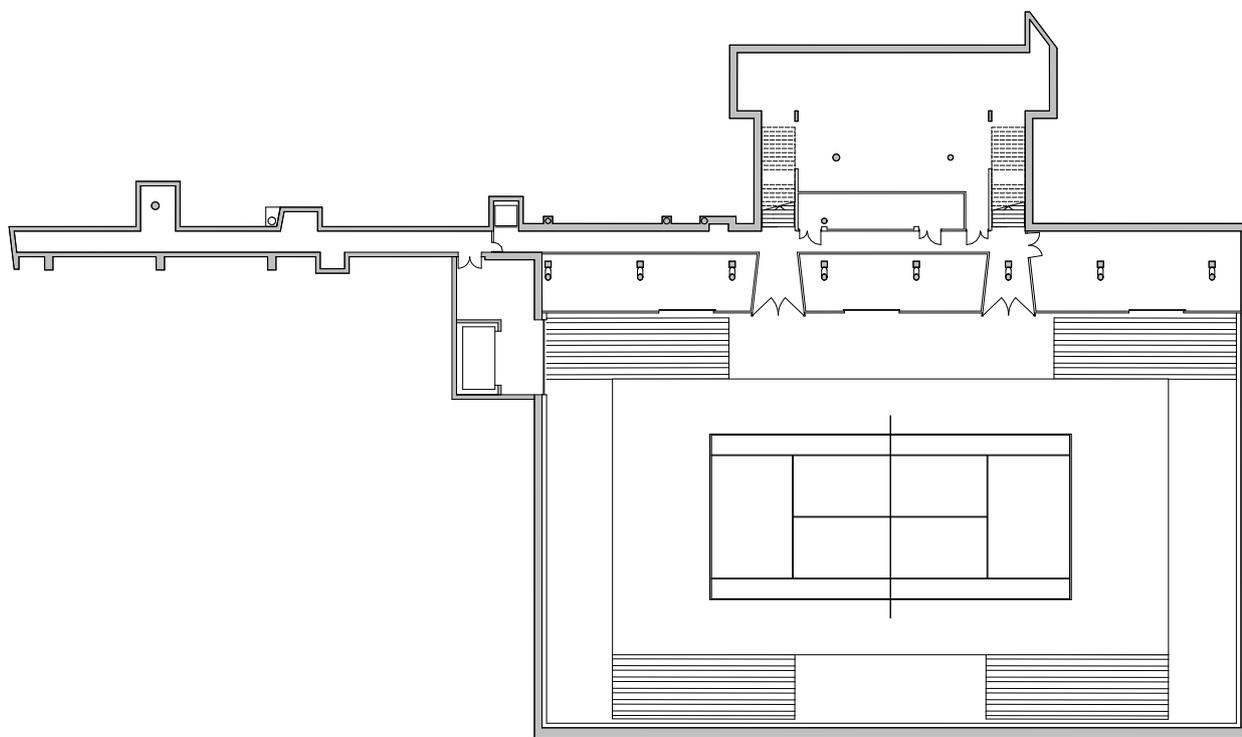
Grundriss 2.UG - Tennisturnier
